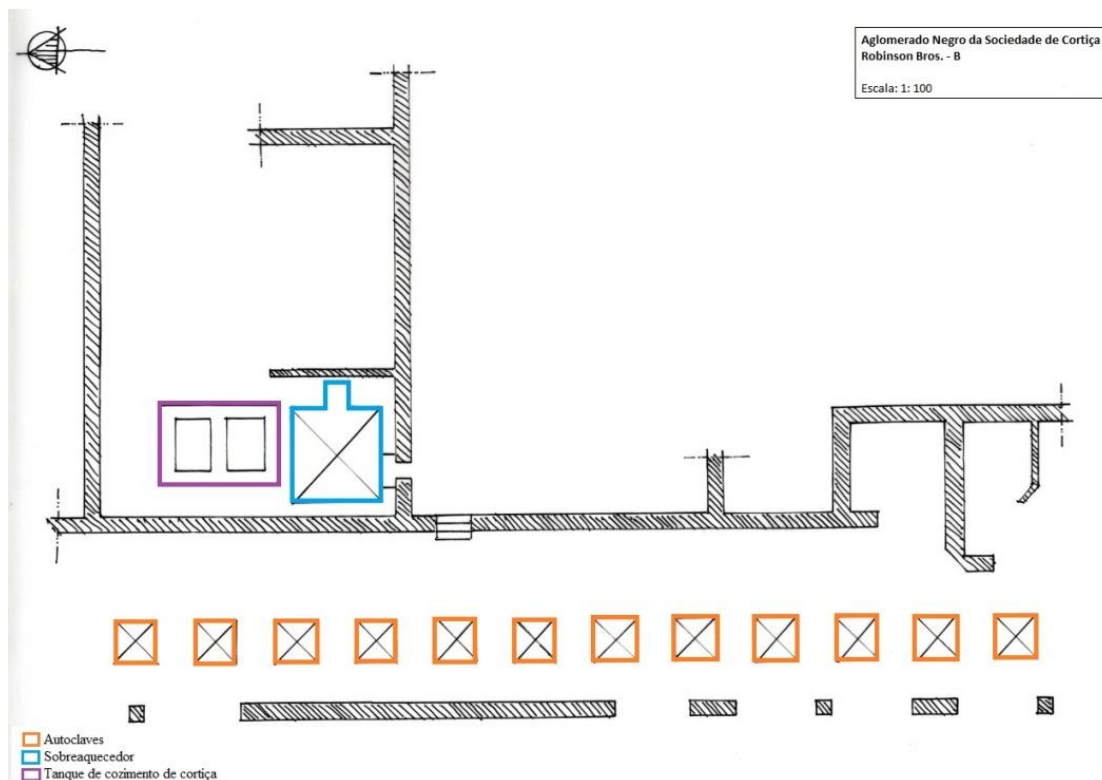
Planta das divisões dos autoclaves e do sobreaquecedor da Fábrica Robinson – Portalegre, em 2016 (Desenho de campo da autora)
